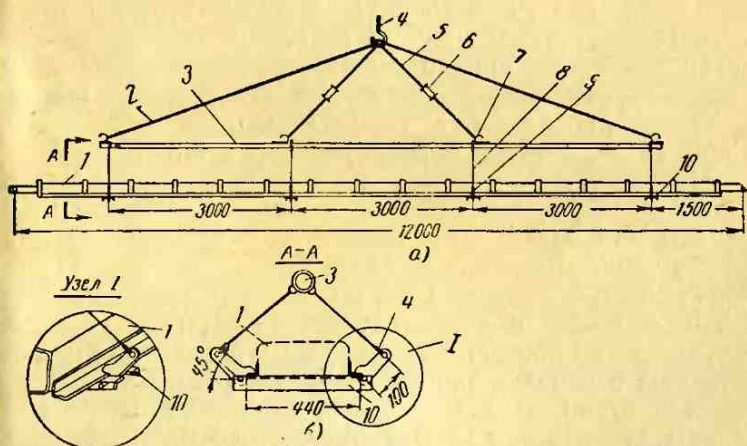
Приспособление для подъема блока шинпровода длиной до 12 м.
